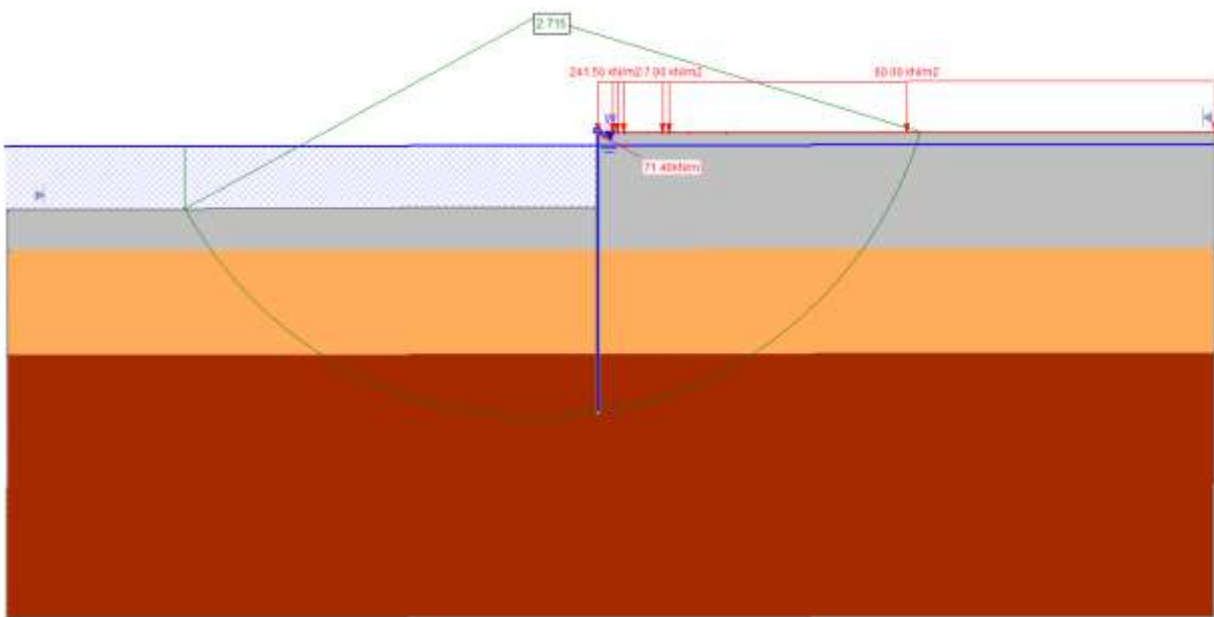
Résultats de la stabilité générale du site en SD fondamental.
